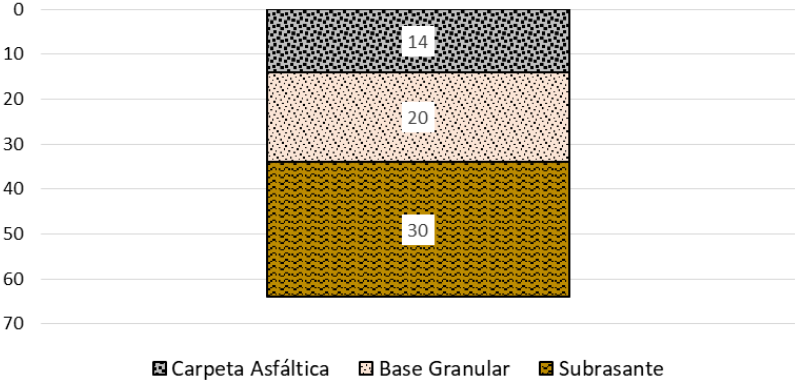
Estructura de Pavimento Flexible Propuesta
